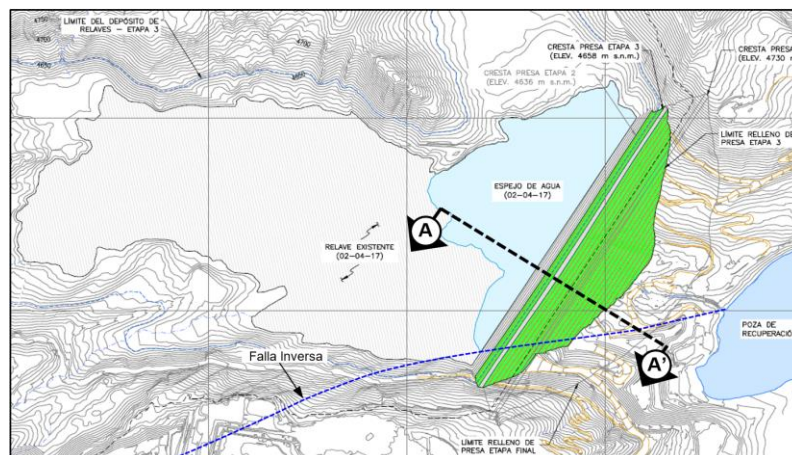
Vista en planta de la sección de análisis A-A'
